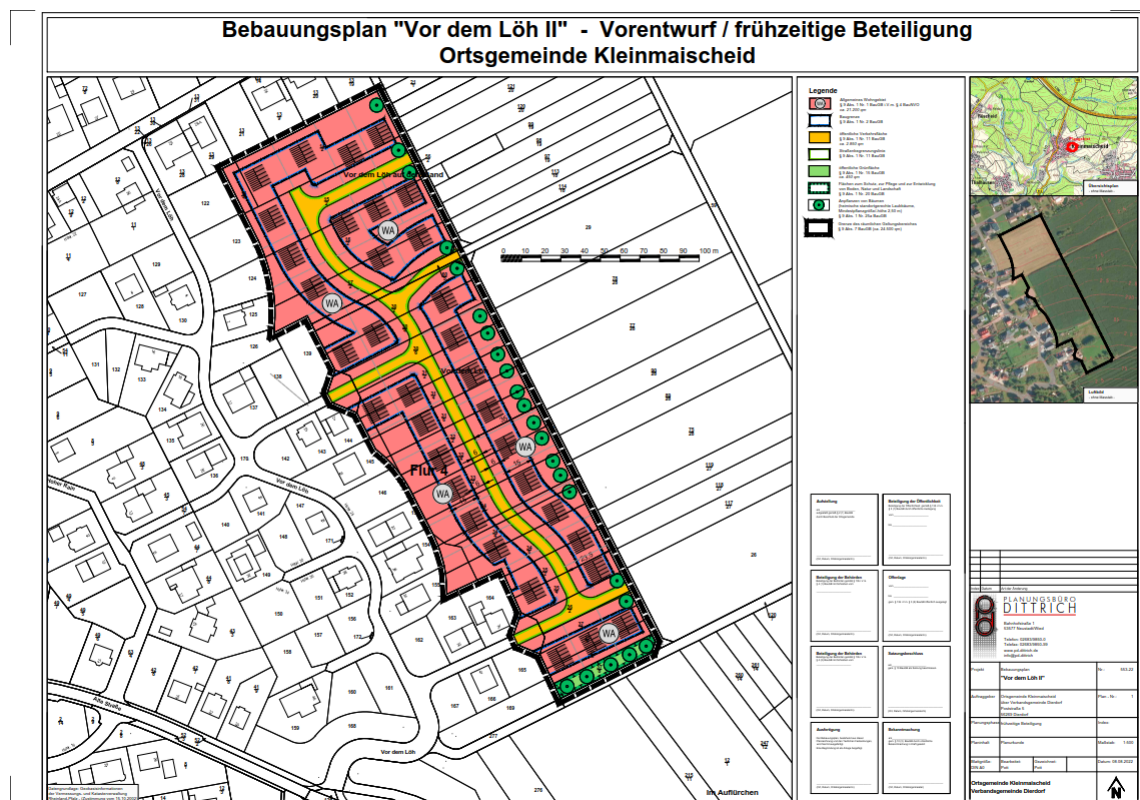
Vorentwurf „Vor dem Löh II“ zum vormaligen Verfahren nach § 13b BauGB
